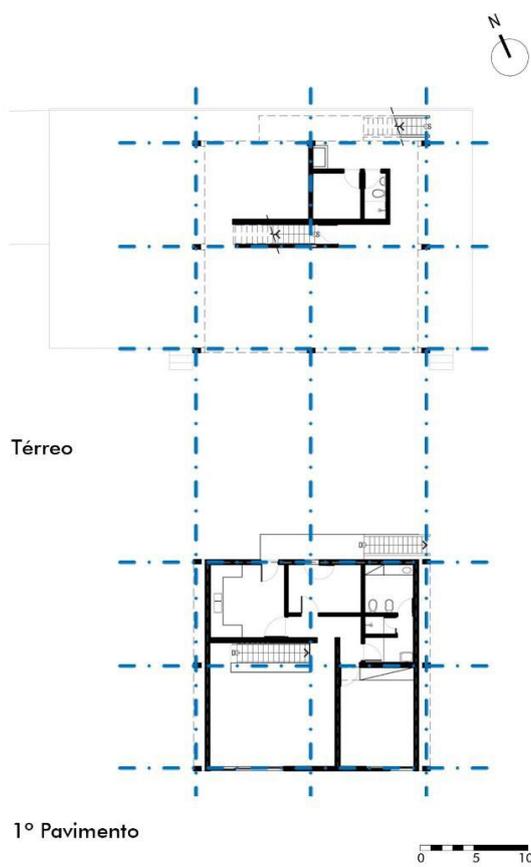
Esquema da malha estrutural indicando o eixo dos pilares nos dois pavimentos. Sem escala.
